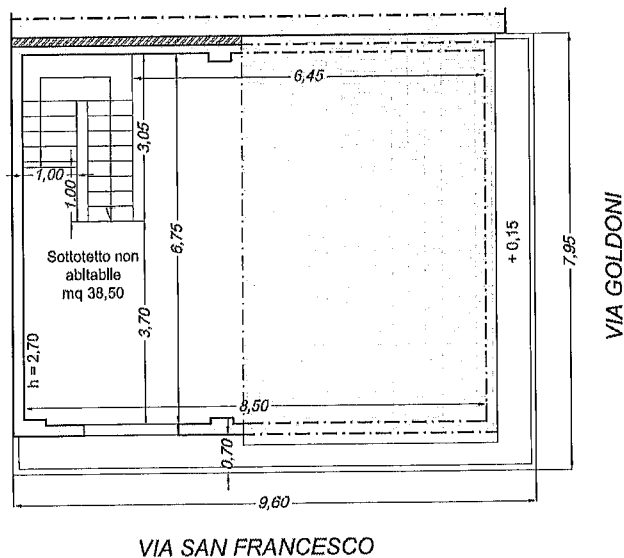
Planimetria Stato di Progetto Piano Sottotetto.
